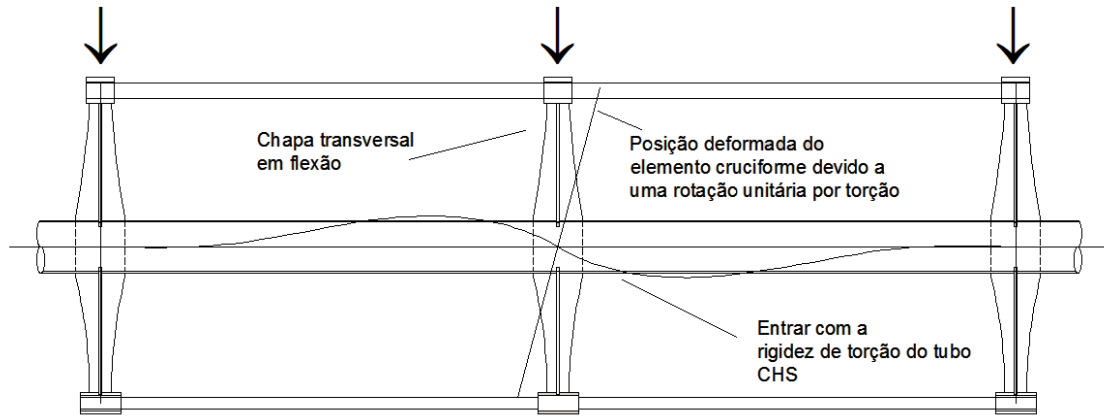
Configuração deformada da treliça Vierendeel devido a uma rotação fora do plano da estrutura
